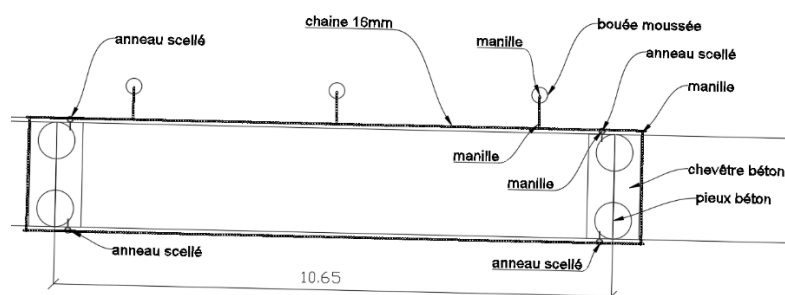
plan masse des travaux à réaliser sur travée non renforcée
